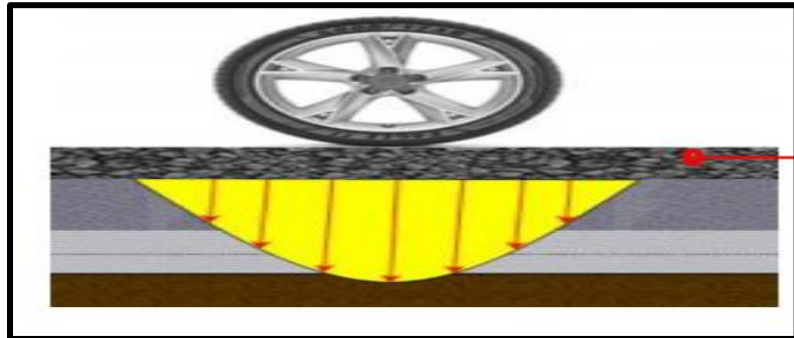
Estructura De Un Pavimento Flexible Típico.
